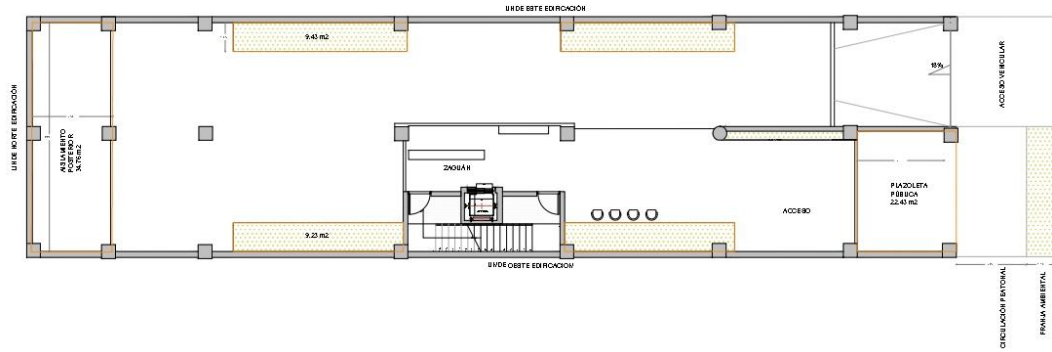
Plano con aislamiento posterior y plaza pública. Elaboración propia.
